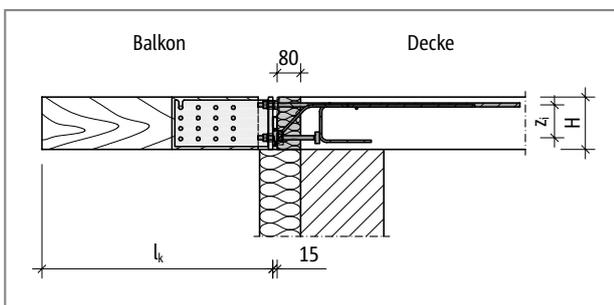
Schöck Isokorb® T Typ SK mit Stahlschwert: Statisches System; Bemessungswerte beziehen sich auf die dargestellte Kraglänge  $l_k$
